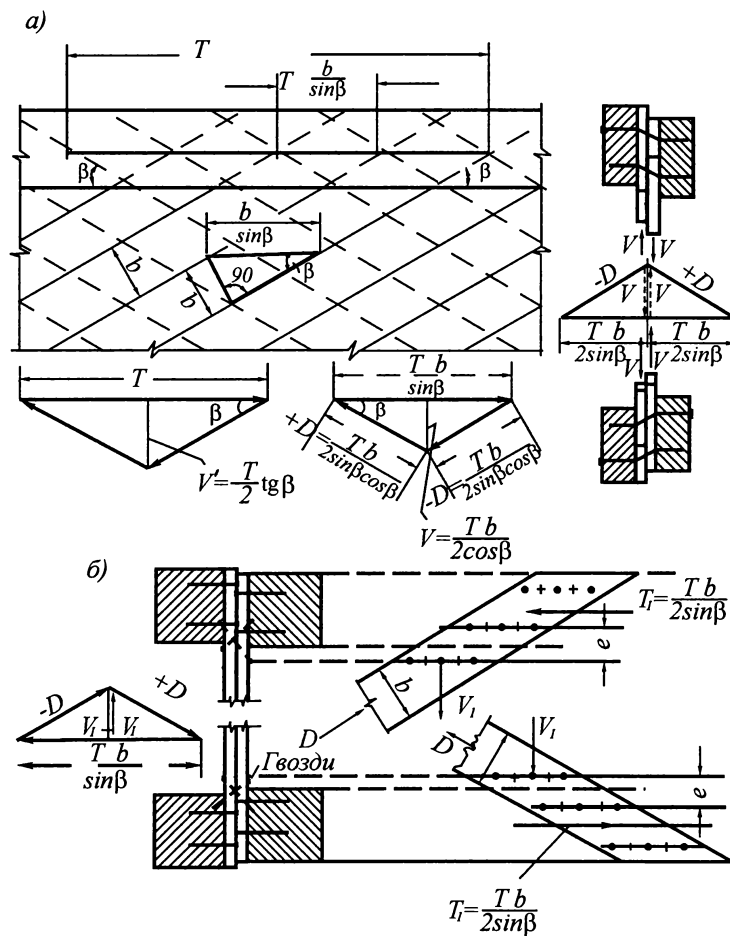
К расчету двутавровой гвоздевой балки с перекрестной стенкой: а) - с поясами из досок; б) - с поясами из брусьев
